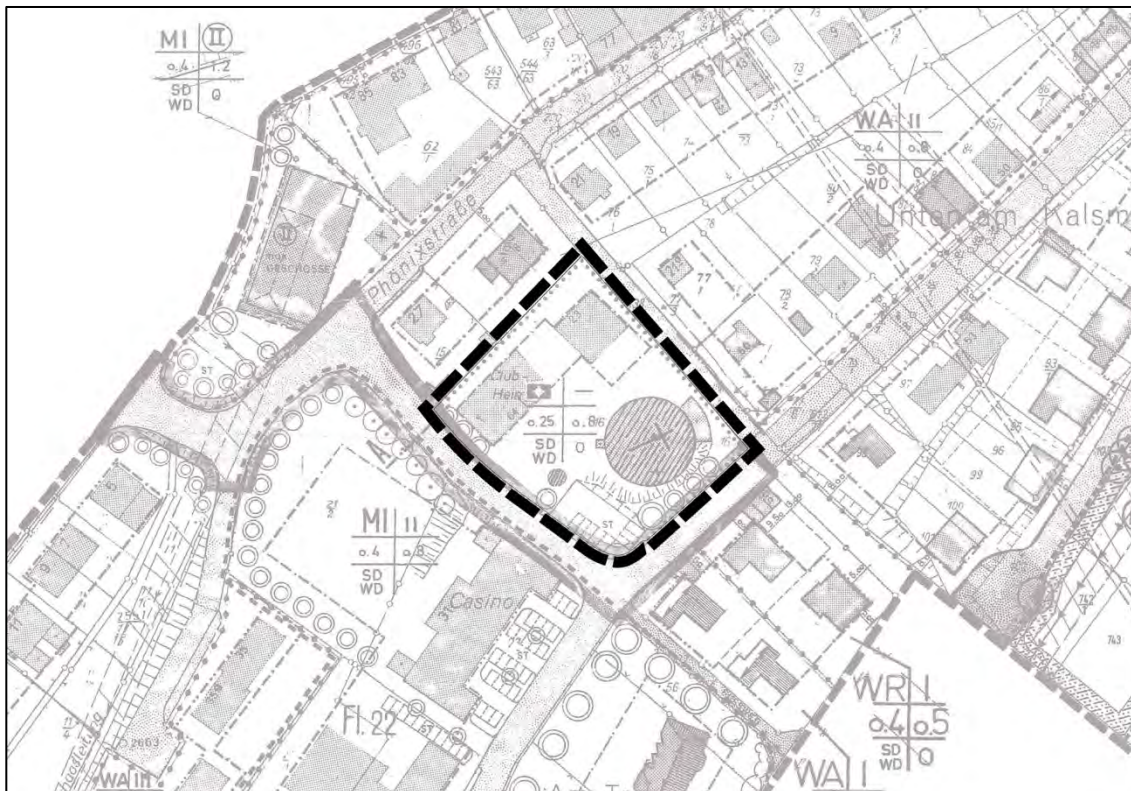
B-Plan Nr. 246 "Am Kalsmunt" (Ausschnitt - unmaßstäblich)
